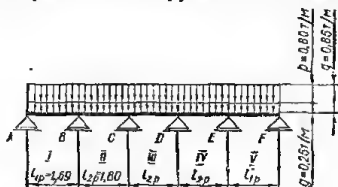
Расчетная схема плиты и расчетные нагрузки.
